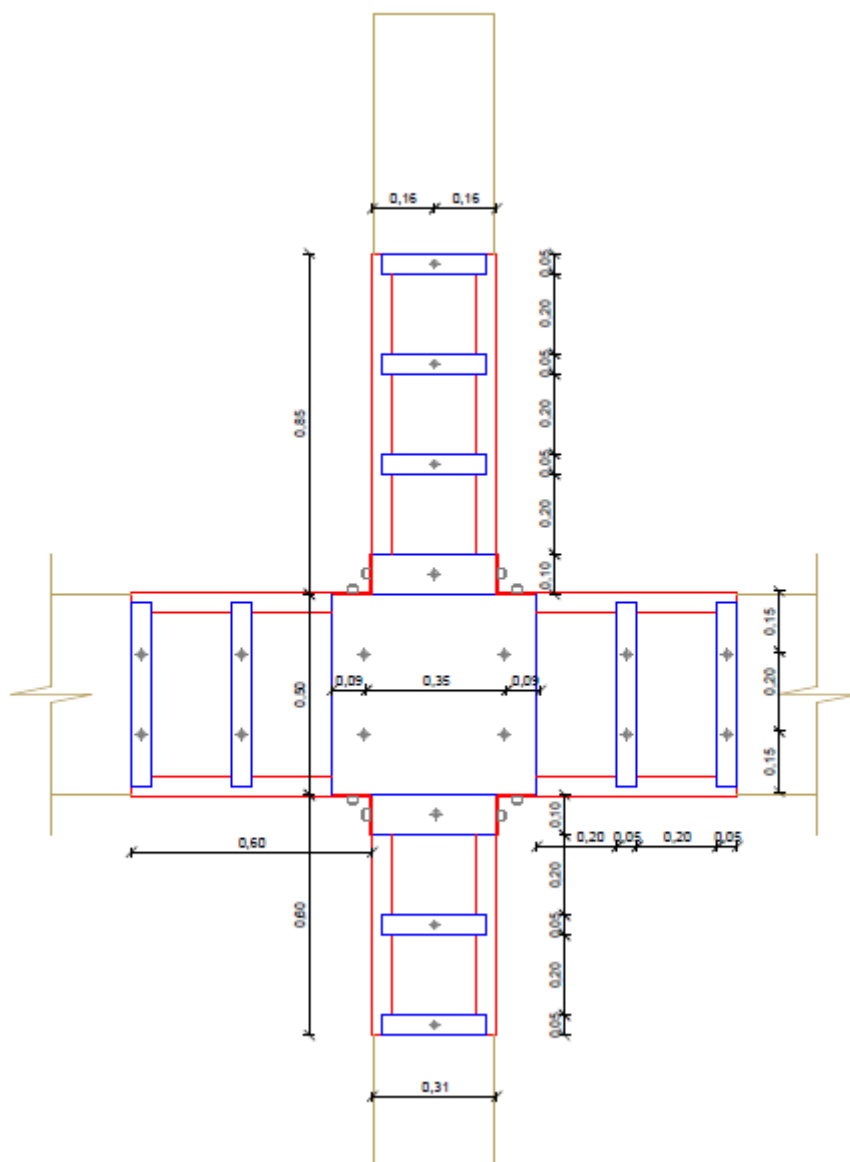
Pormenorização da solução de reforço do provete IPA-1
